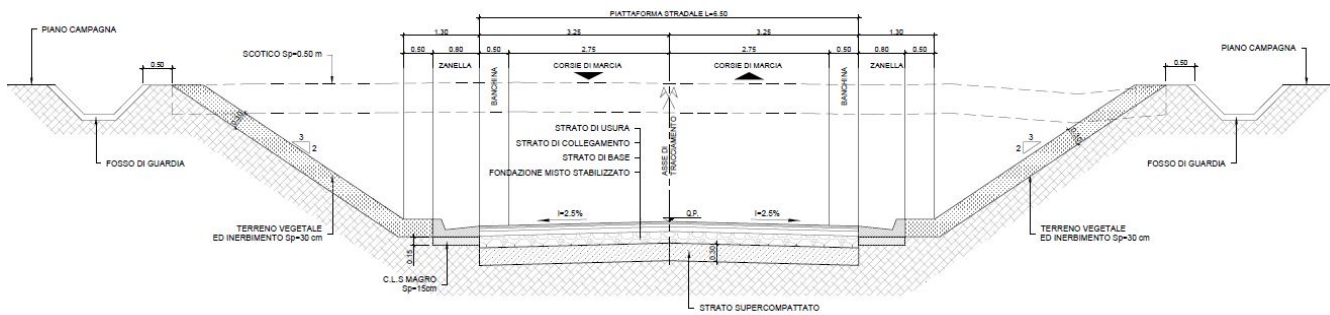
Dest. Particolare 6.5m - sezione tipo in trincea
